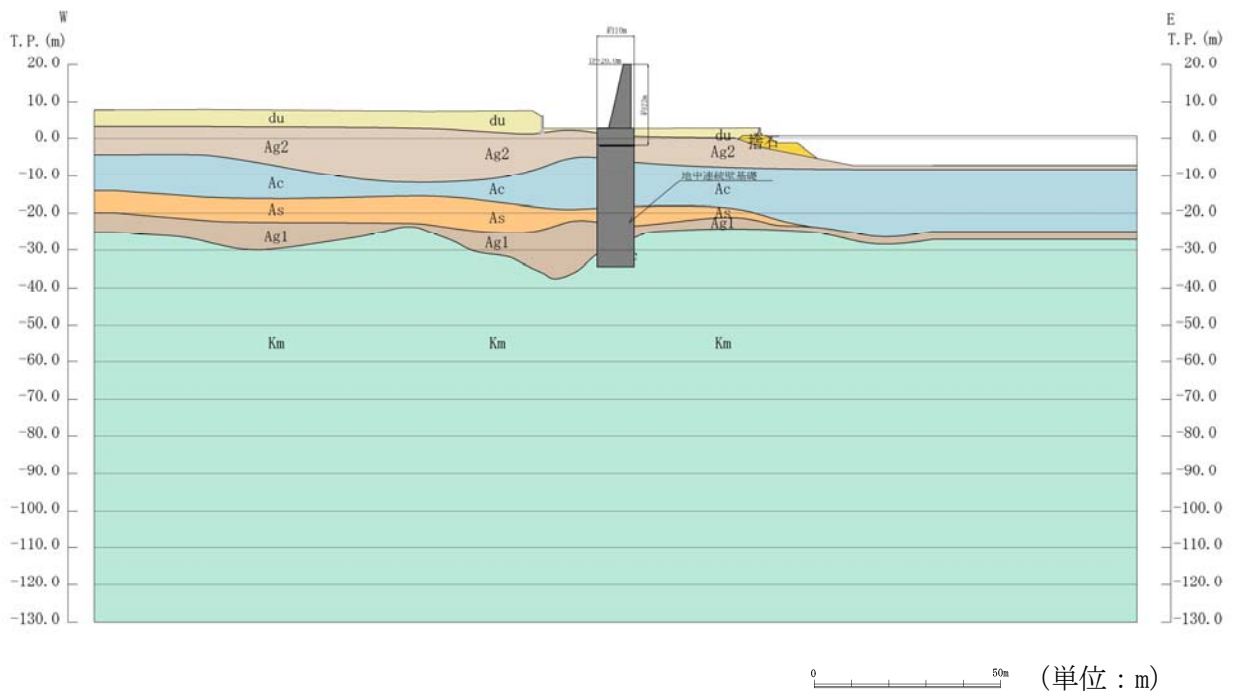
(4) 鉄筋コンクリート防潮壁 評価対象断面図 (④-④断面)
